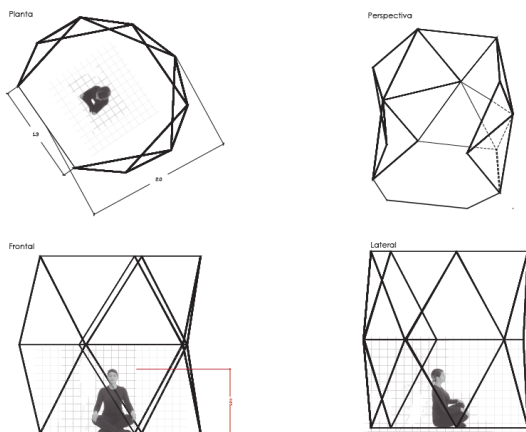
Módulo de meditación. Autoría propia. Pág: 88
